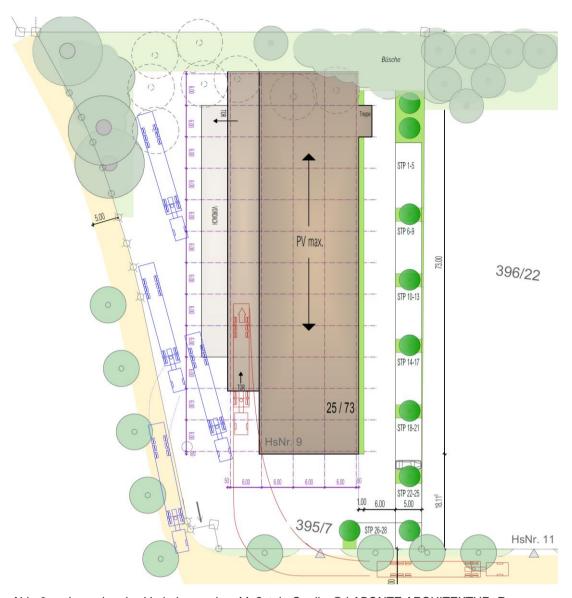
Lageplan des Vorhabens, ohne Maßstab, Quelle: © LABONTE ARCHITEKTUR, Rosenheim, Stand 04.08.2025
